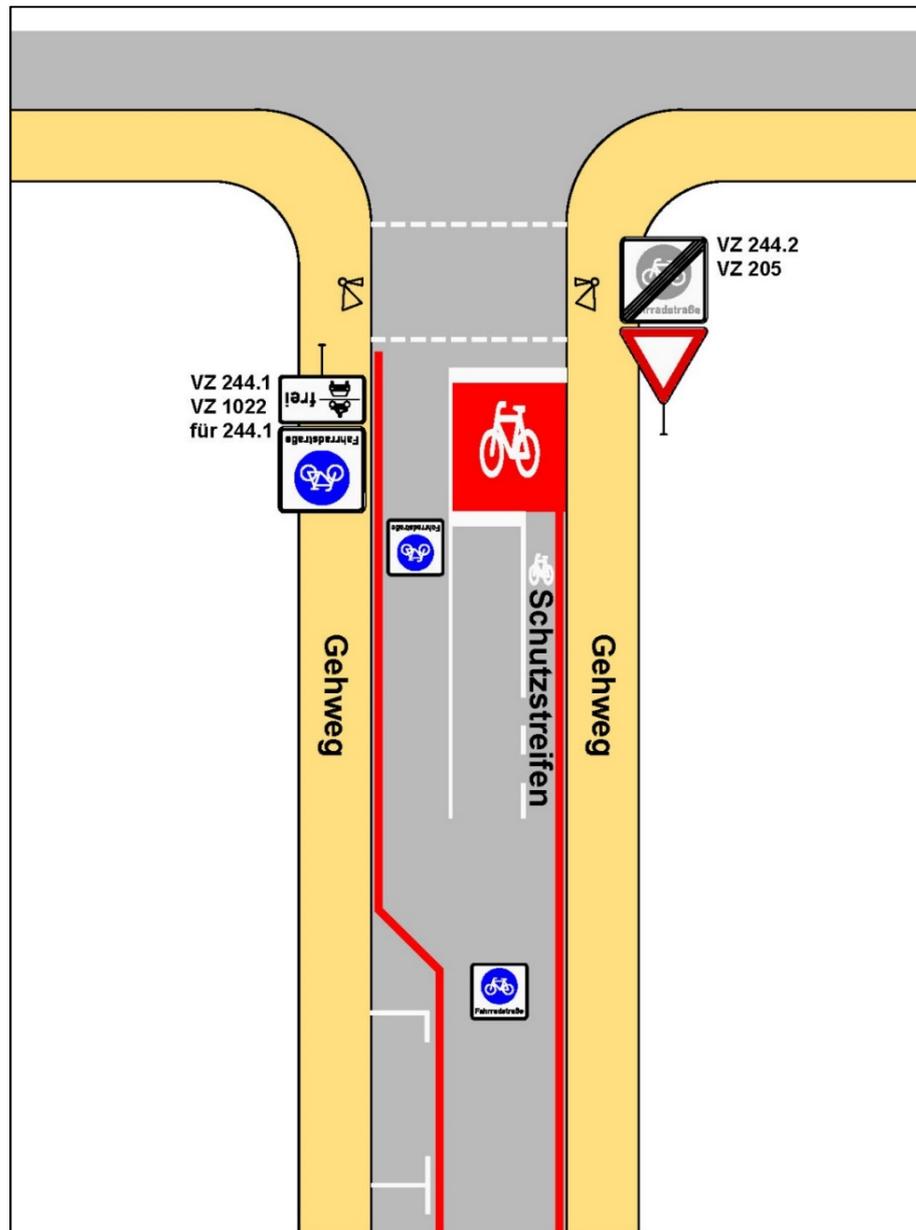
Signalisierte Knotenpunktzufahrt einer Fahrradstraße (Knotenpunkt mit einer Vorfahrtstraße)
